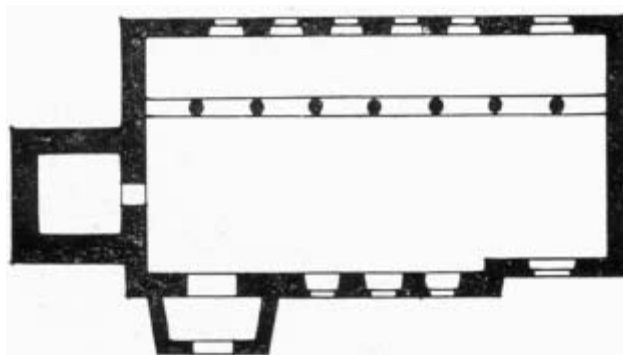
Grundriss der alten Pfarrkirche; Abb. 8 bis 10 aus der Festschrift zum 100. Jahrestag der Konsekration der Pfarrkirche St. Willibrord Plaidt
